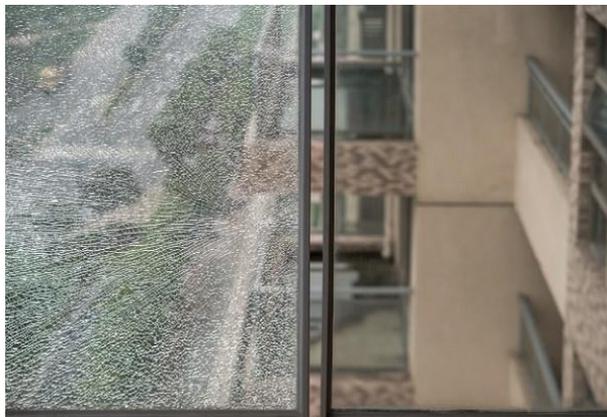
Пример разрушения ламинированного стекла в светопрозрачных фасадах
